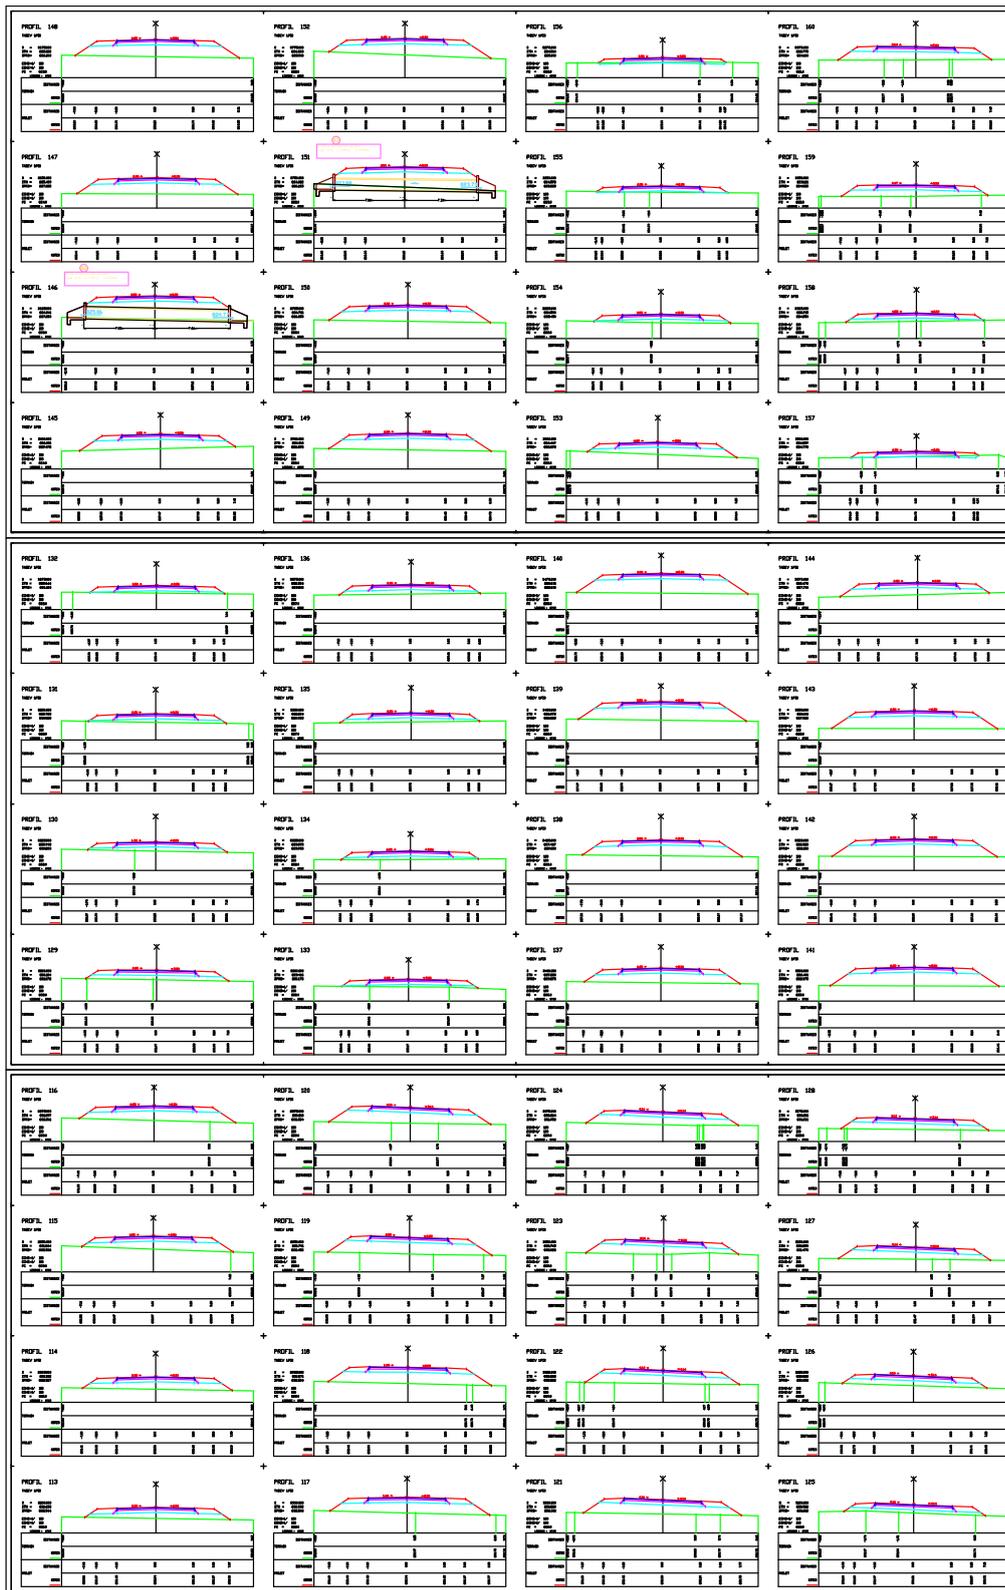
PROFIL EN TRAVERS TYPE DE NOTRE PROJET
